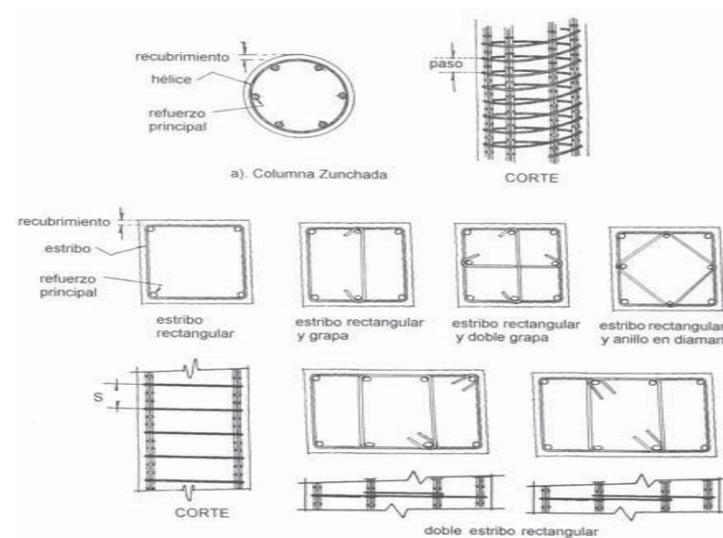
Columnas, circular y rectangular con su refuerzo longitudinal y transversal.
